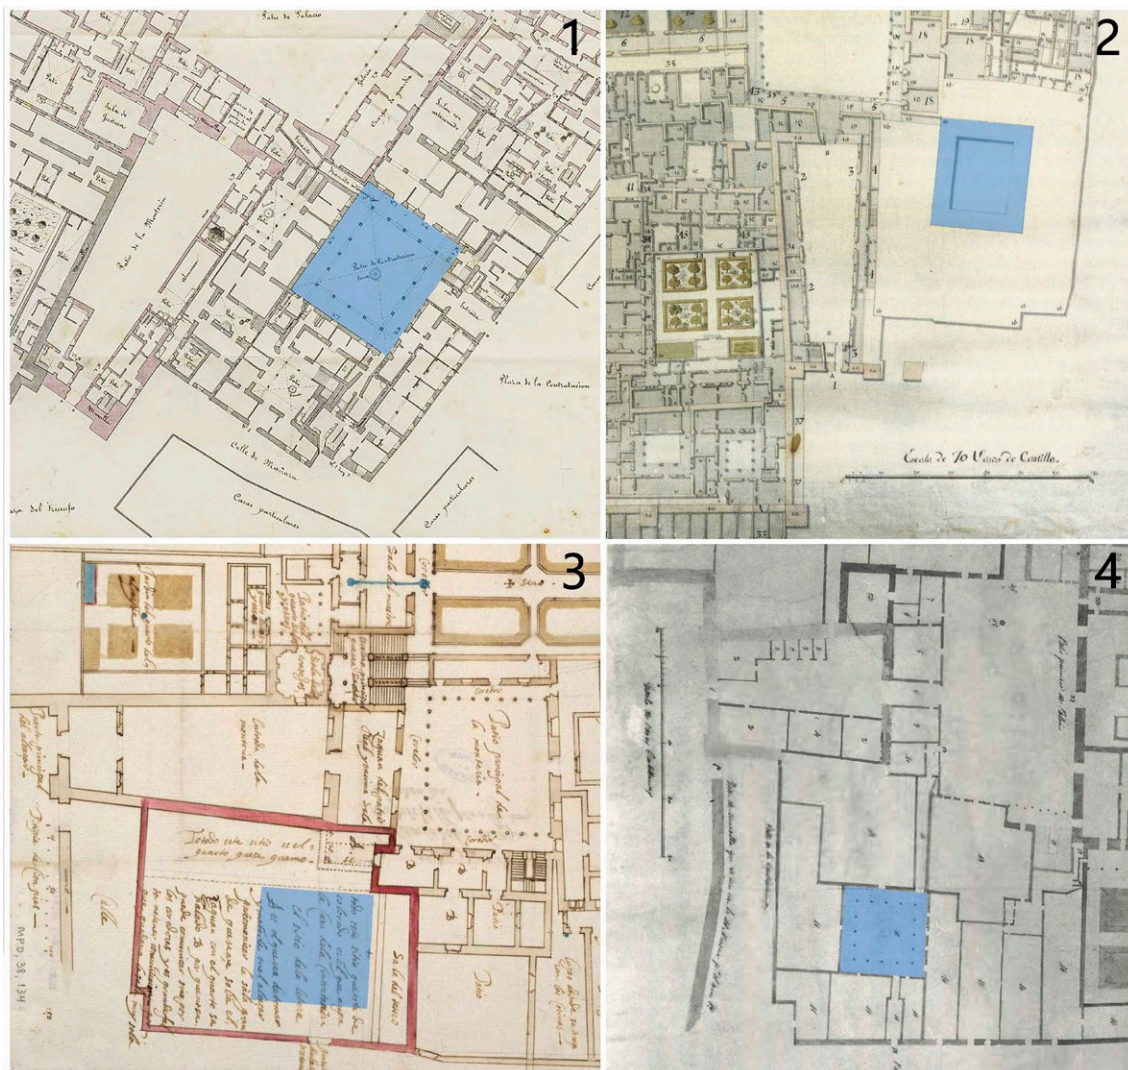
Localización del sector sobre la planimetría histórica, Patio principal, © Fernando Díaz Moreno, Planimetrías:
